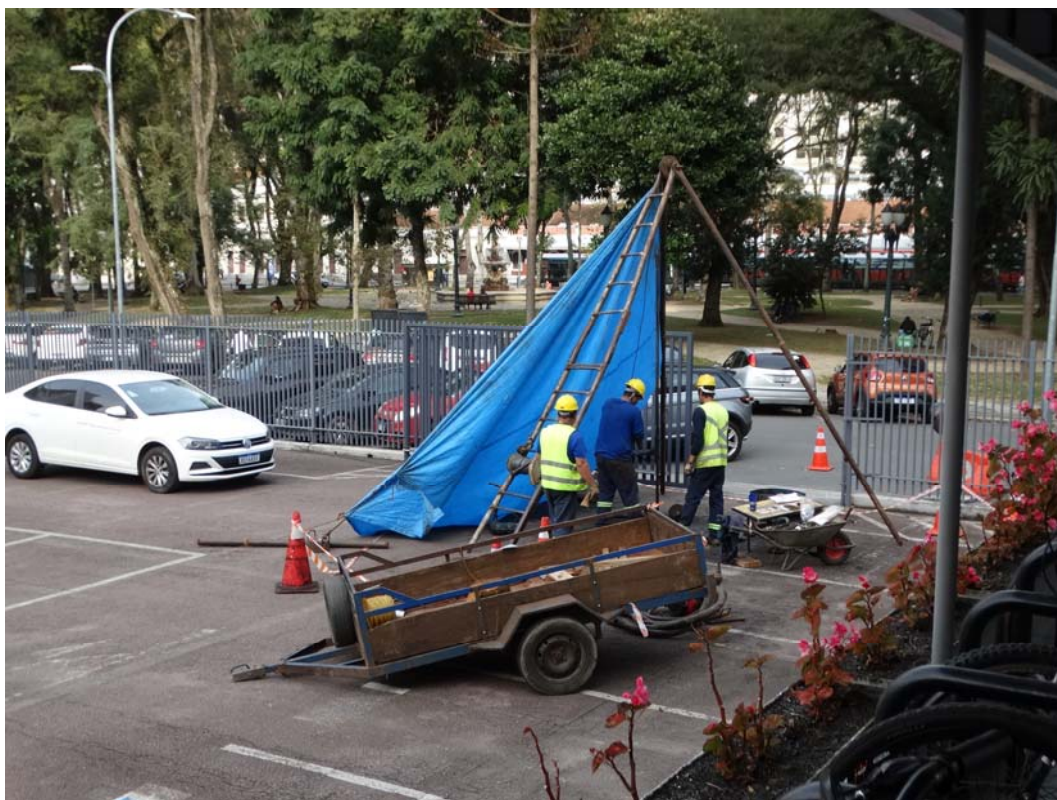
Outra imagem da perfuração do furo SP-06. Foto do autor.
